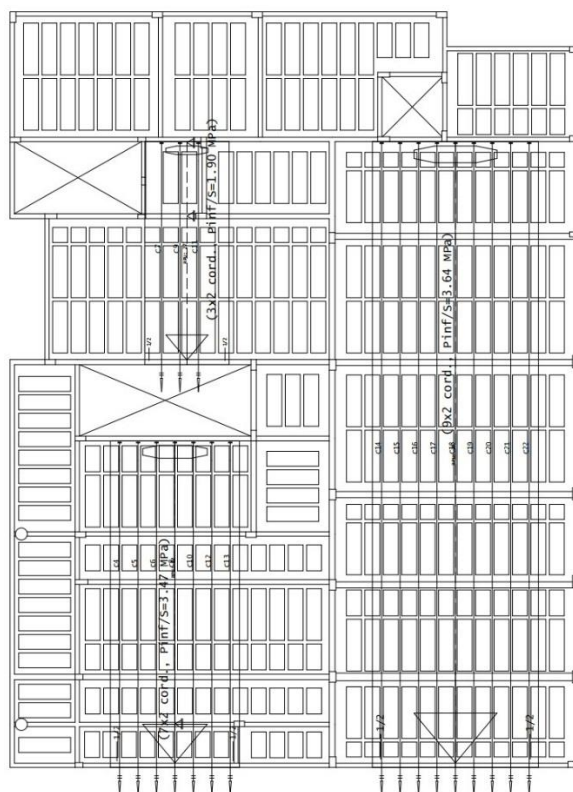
Traçado de RPUs verticais e distribuição de cabos do sistema de laje nervurada unidirecional protendida no TQS. (Fonte: Autoria própria; 2023)
